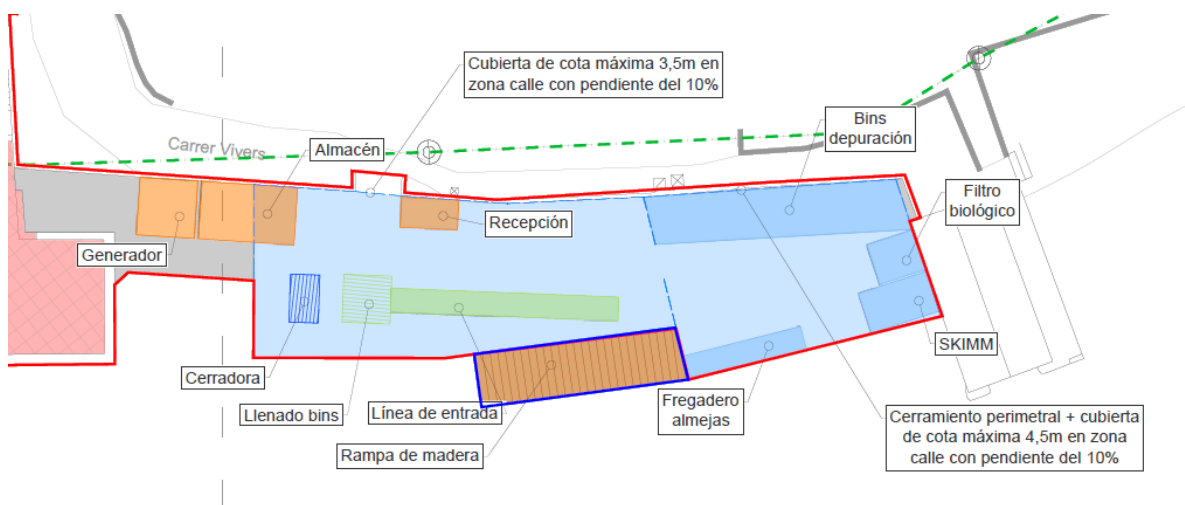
Planta de la solución propuesta en las parcelas 8, 9 y 10.
